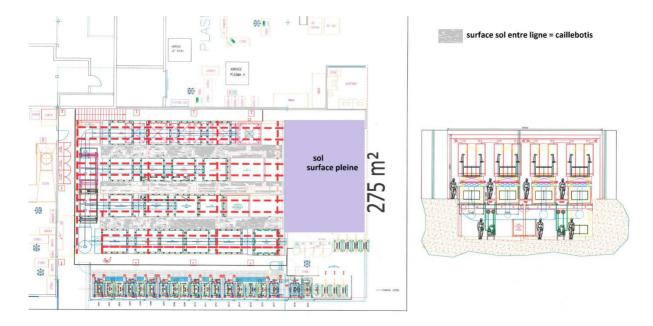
Plan et coupe du futur sous-sol de l'atelier de traitement de surface
